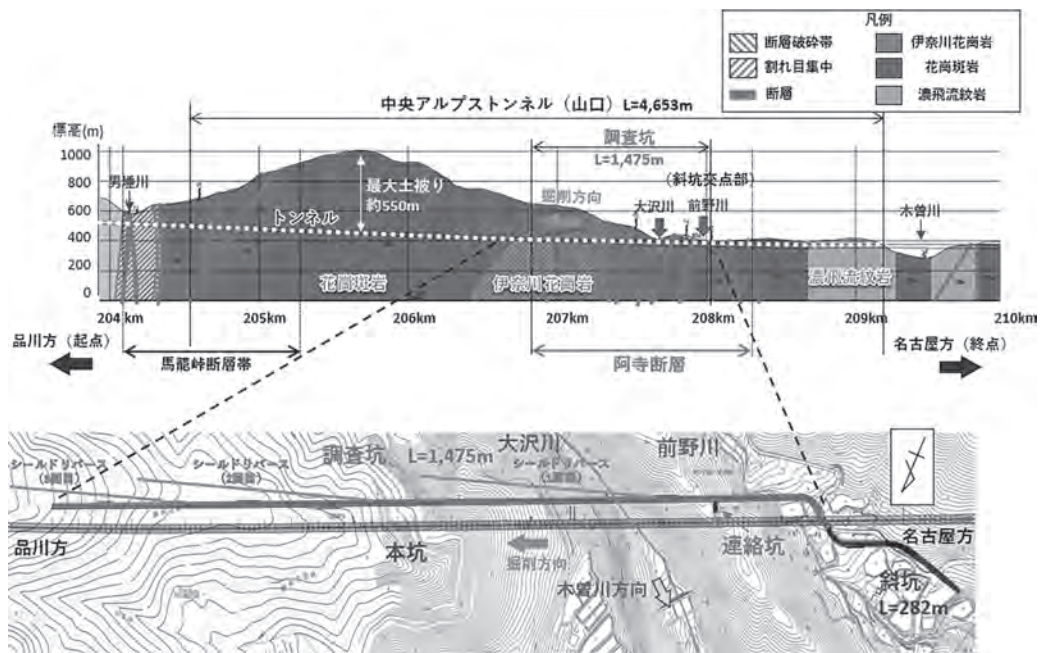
地質縦断面図 (上) 及び調査坑周辺の平面図 (下)
